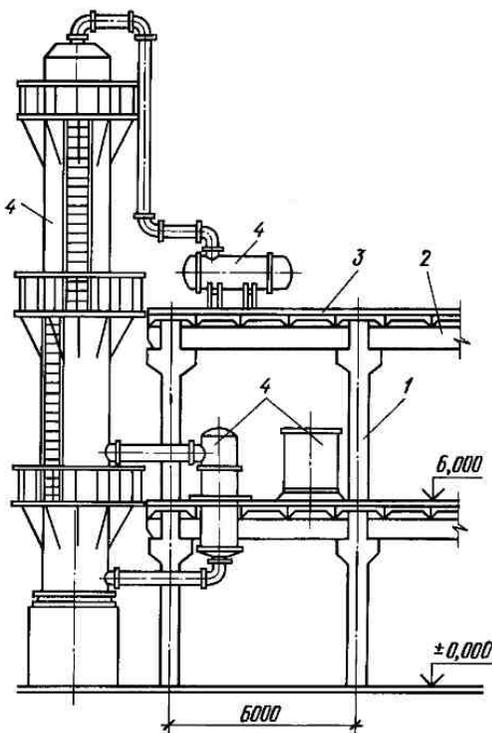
Этажерка промышленного здания: 1 — колонна, 2 — ригель, 3 — рабочая площадка, 4 — технологическое оборудование
